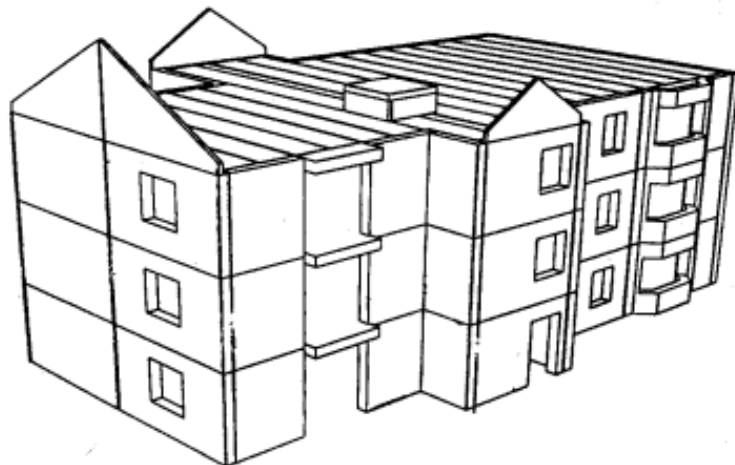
Exemple d'une construction en panneaux portants (Leçon 2 – Systèmes de construction en préfabrication)<sup>5</sup>
